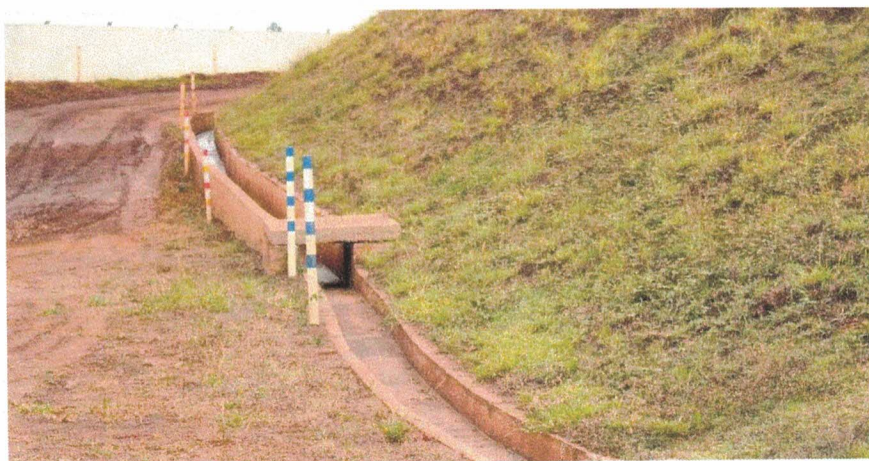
Canaleta de concreto armado disposta a jusante do talude da berma intermediária.
